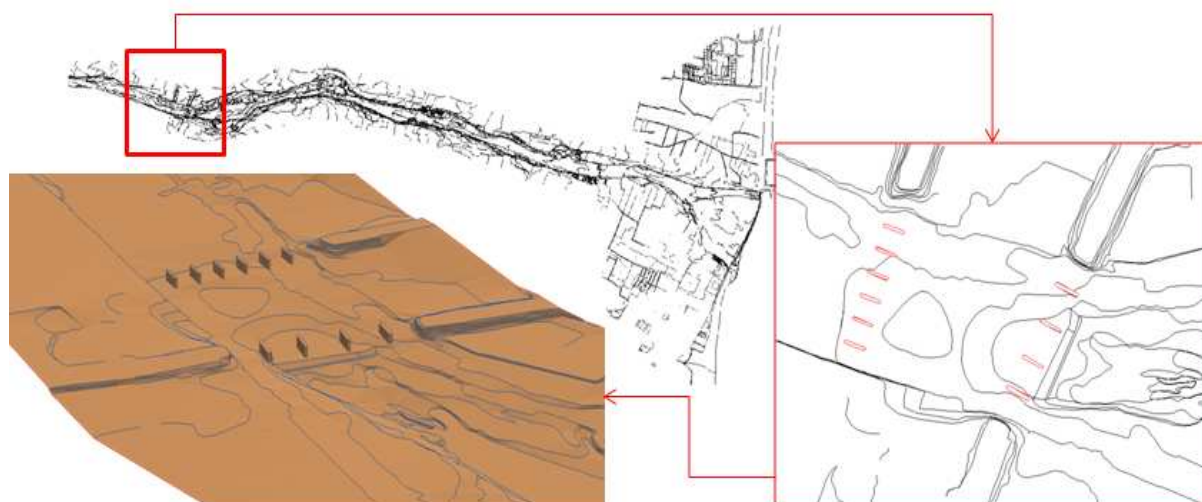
Topografía del tramo analizado y detalles de las pilas de dos de los puentes existentes
